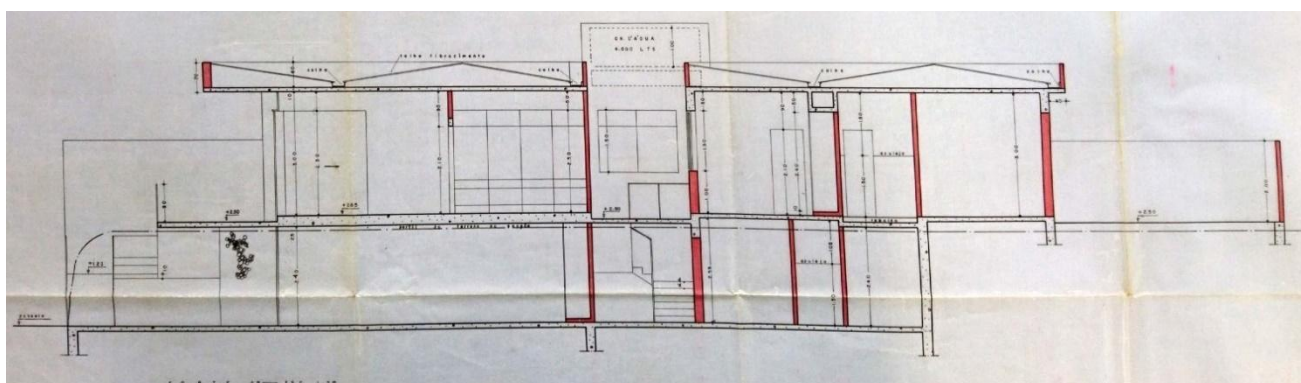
Corte AB da edificação. Detalhe prancha 2 de 3. Fonte: APCBH.
